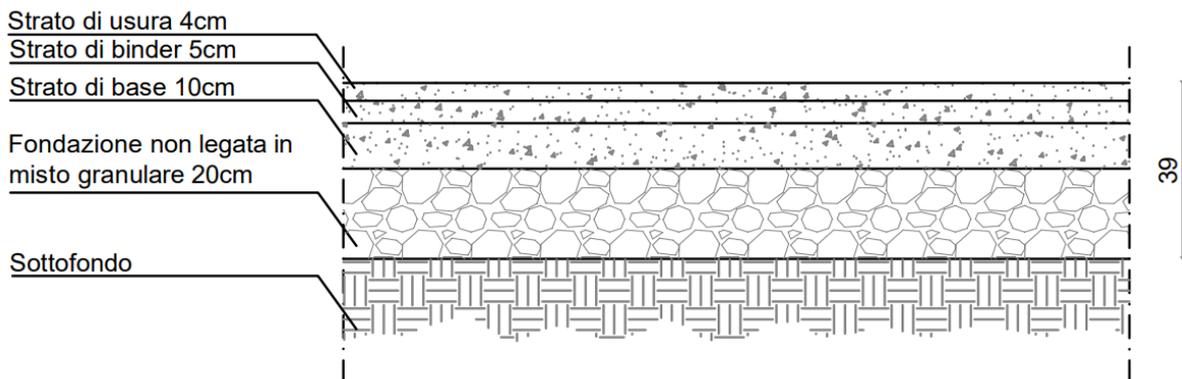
viabilità di accesso per la manutenzione: dettaglio pavimentazione impermeabile bituminosa
